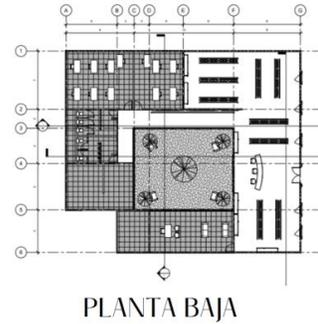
Planos en Archicad Fuente: Ortiz Martínez (26).
